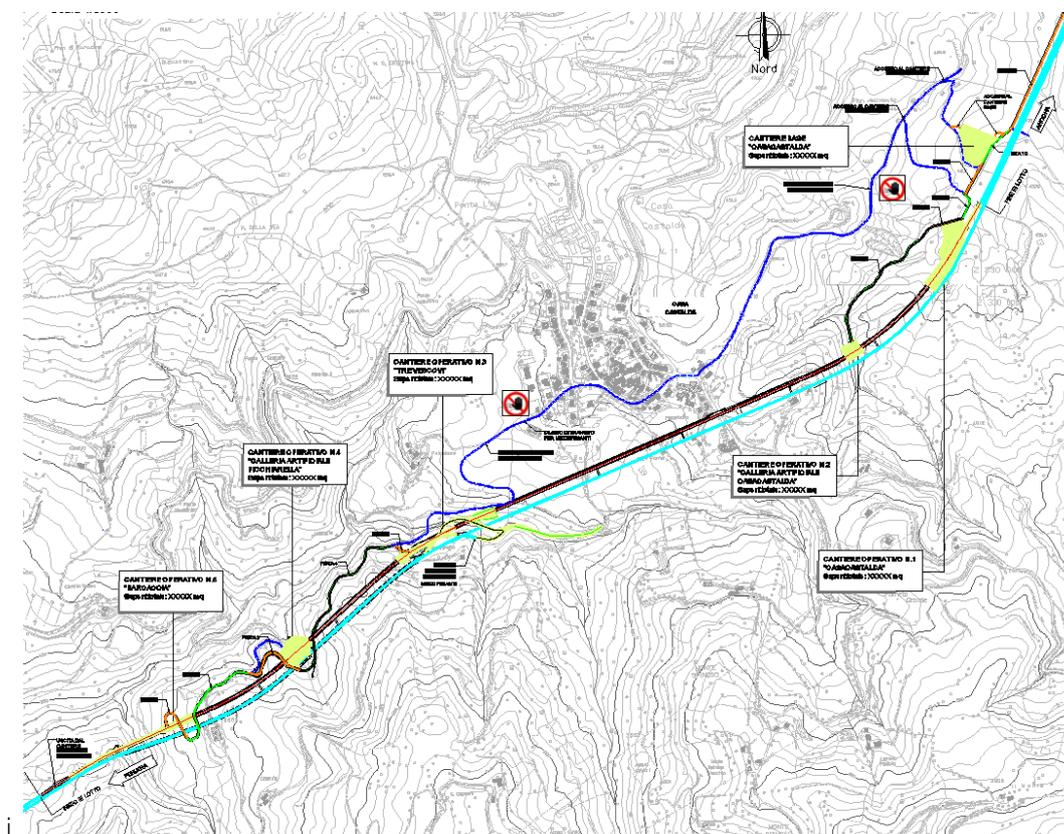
Planimetria con individuazione dei cantieri base e operativi.
